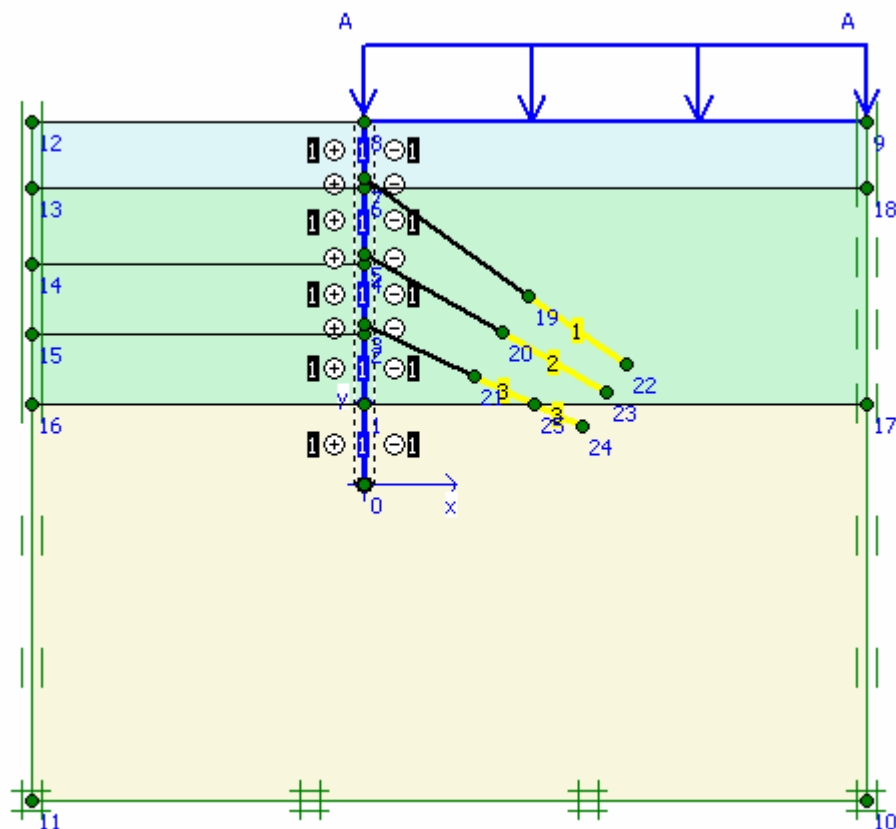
Modelo de Cálculo utilizado para a escavação
